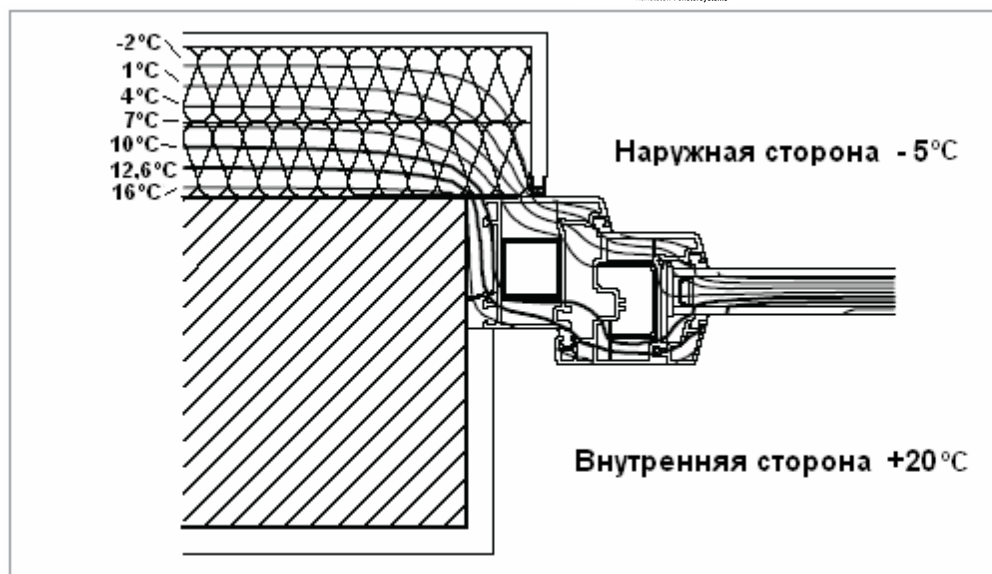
Бетонная стена с наружной изоляцией. Окно из профиля ПВХ, монтаж снаружи встык.
